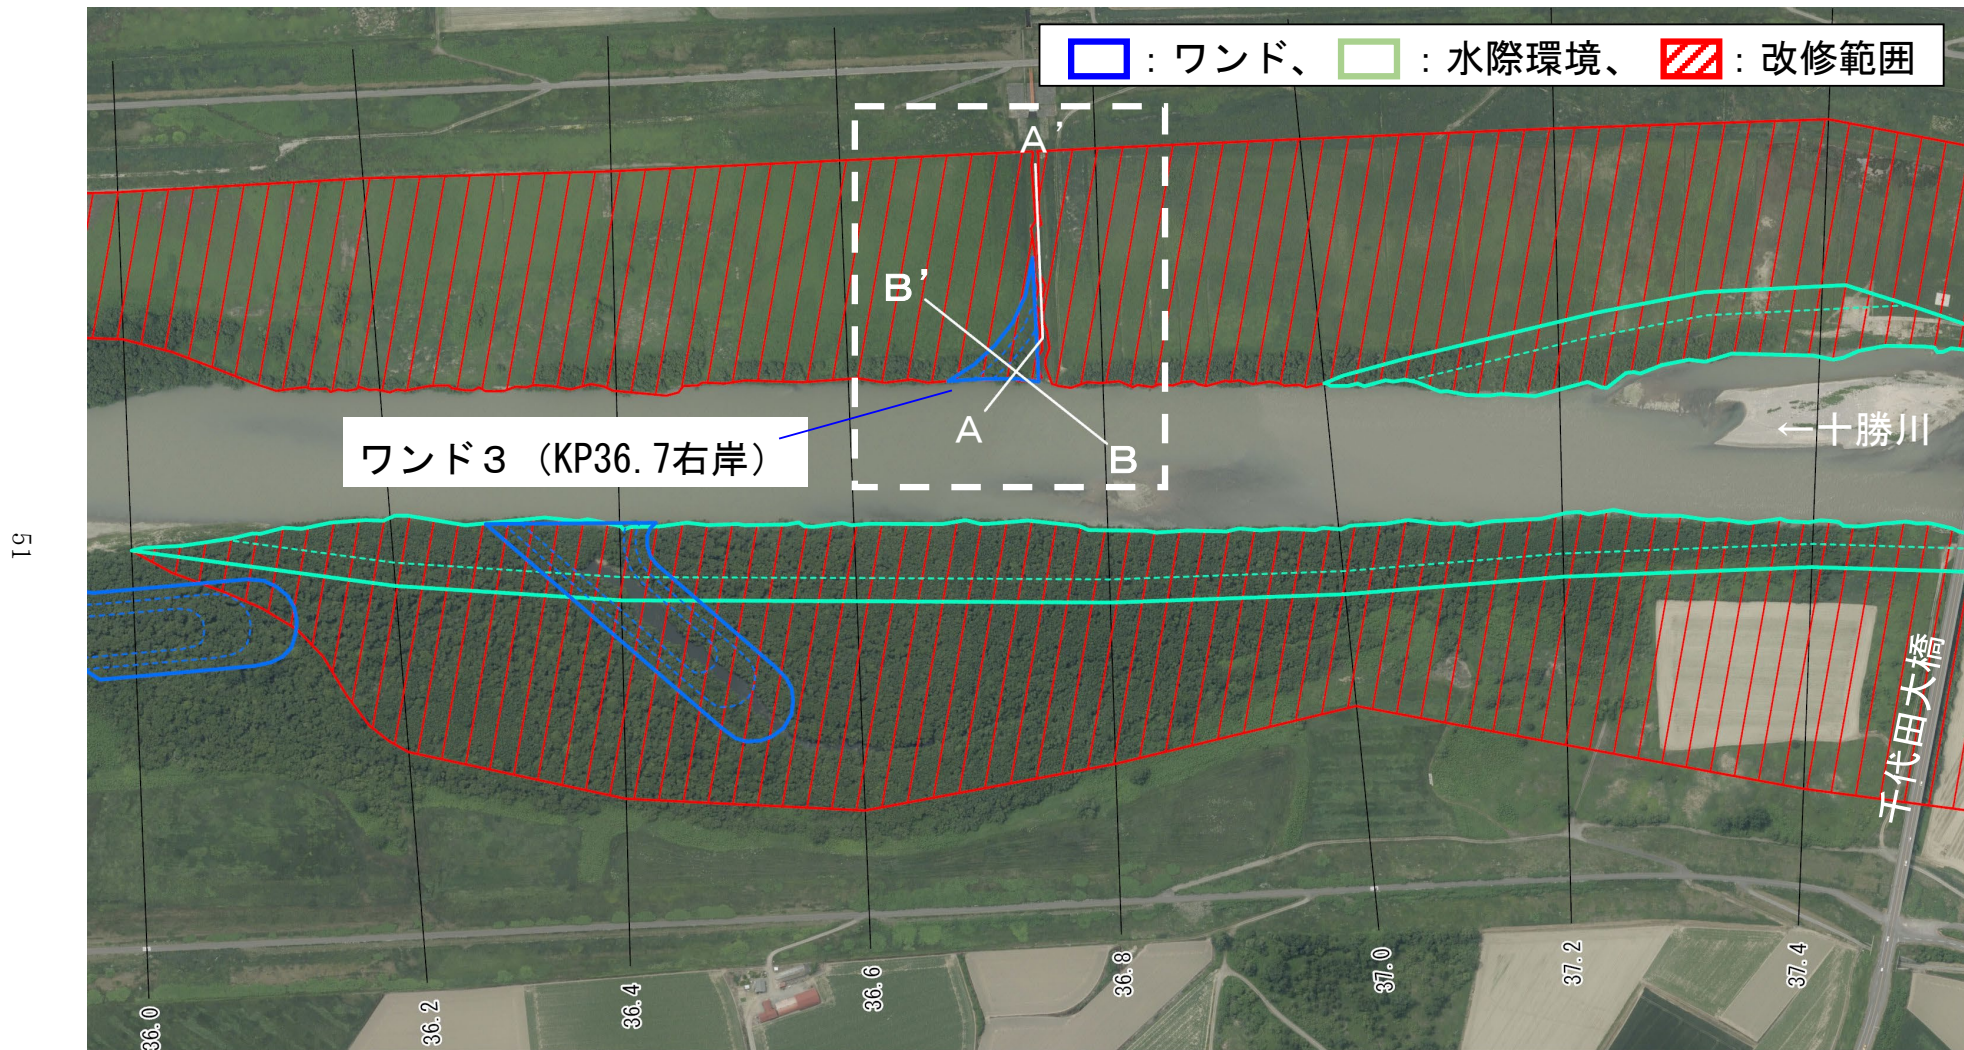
ワンド3 (KP36.7右岸) の平面配置図
